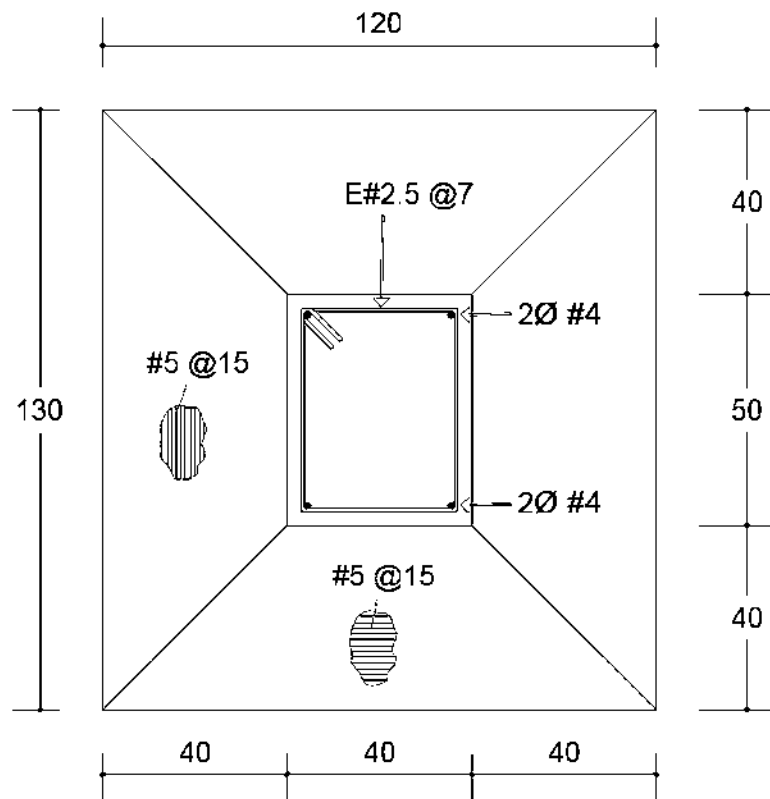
(g) Vista en planta de la zapata y dado de cimentación, (cm)
